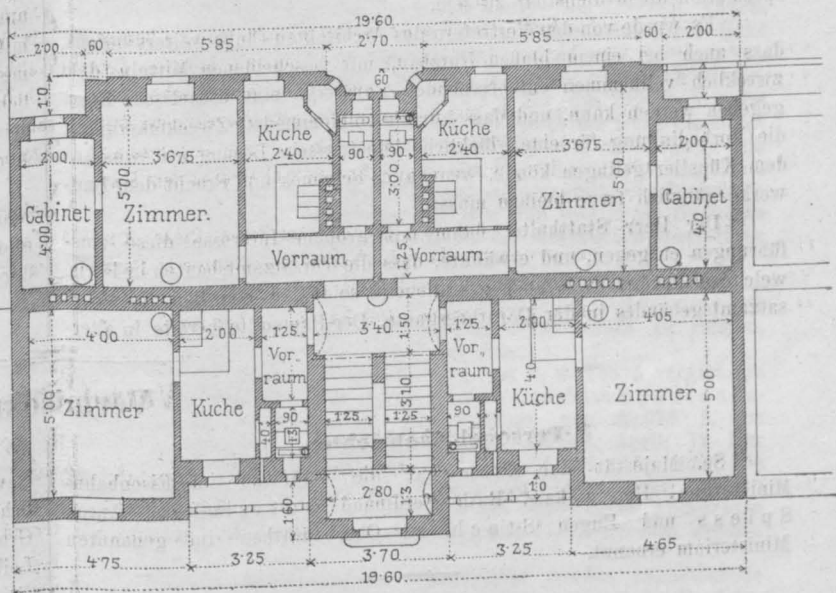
Ebenend-Grundriss der Type C1.
